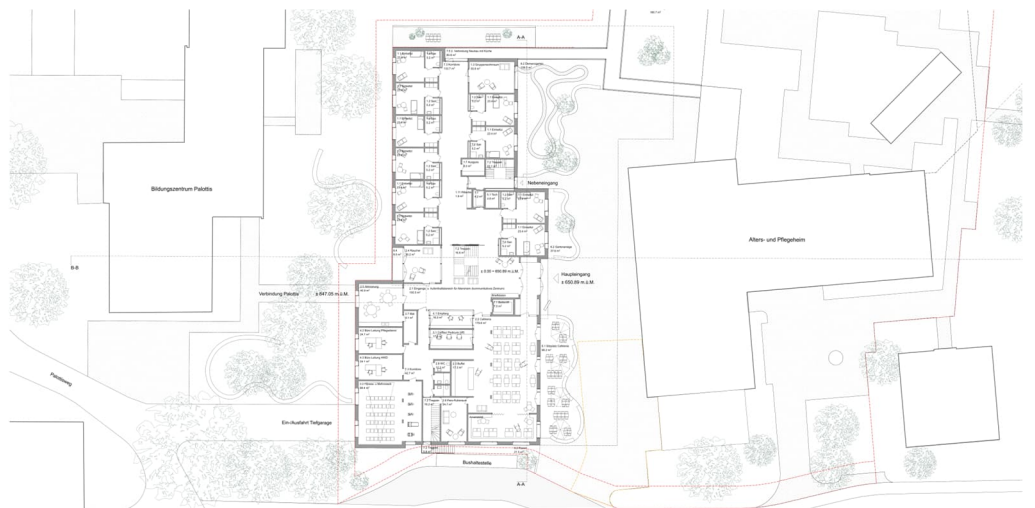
Grundriss Erdgeschoss Elin und Eni (massstabslos)
